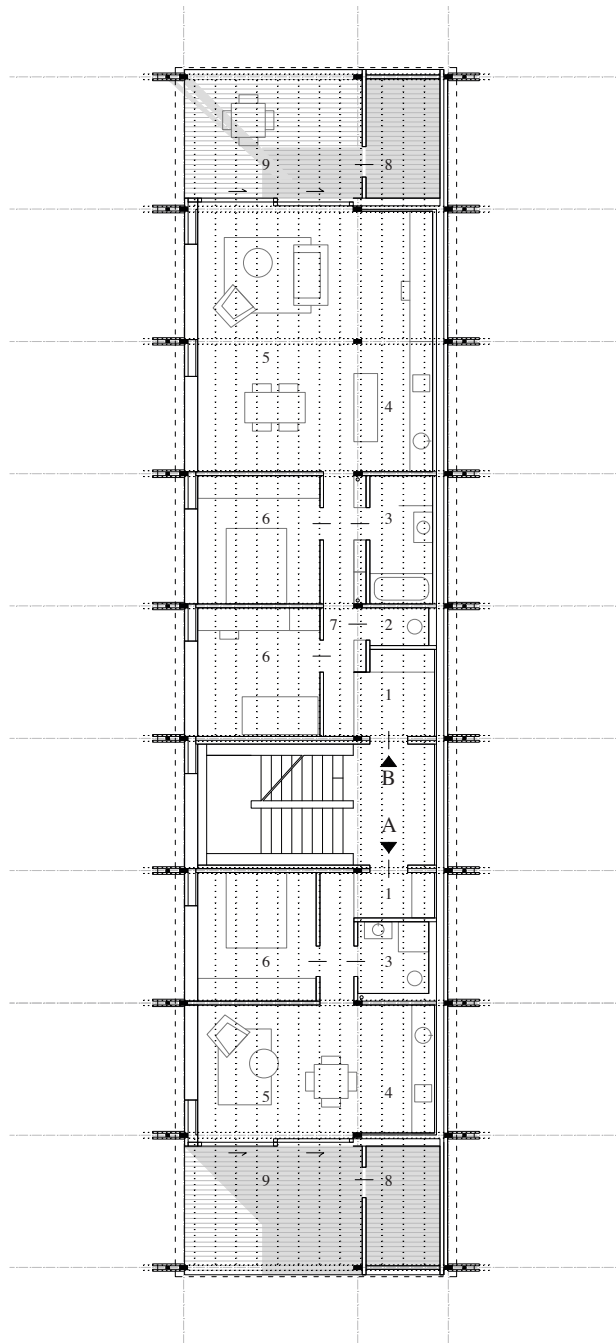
Typ A Regelgeschoß Grundriss M 1:200
